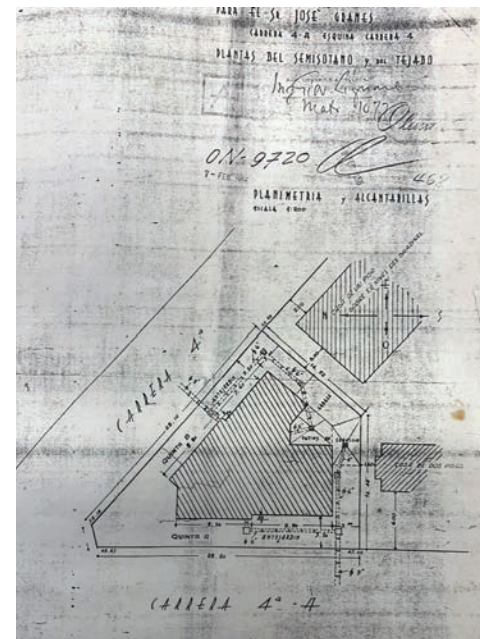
Proyecto de casa Granés (archivo Bermúdez) / Planimetria di progetto di casa Granés (archivo Bermúdez)
